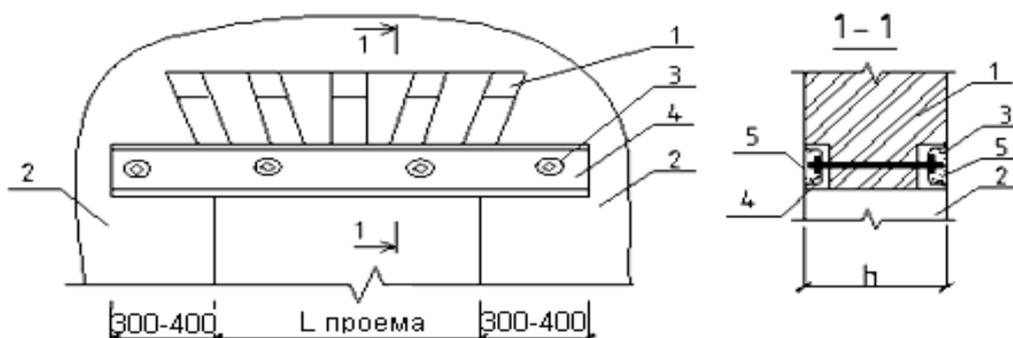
Схема подведения разгружающей балки под усиливаемую перемычку:
